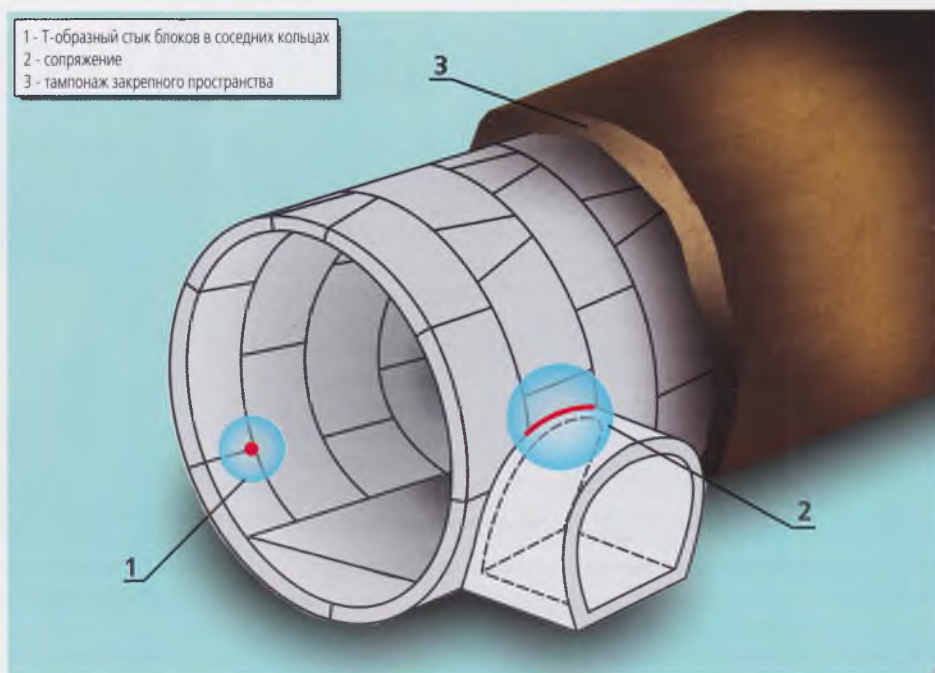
Наиболее уязвимые места в гидроизоляционной мембране из сборных железобетонных блоков в обделках тоннелей, сооруженных щитовым способом
